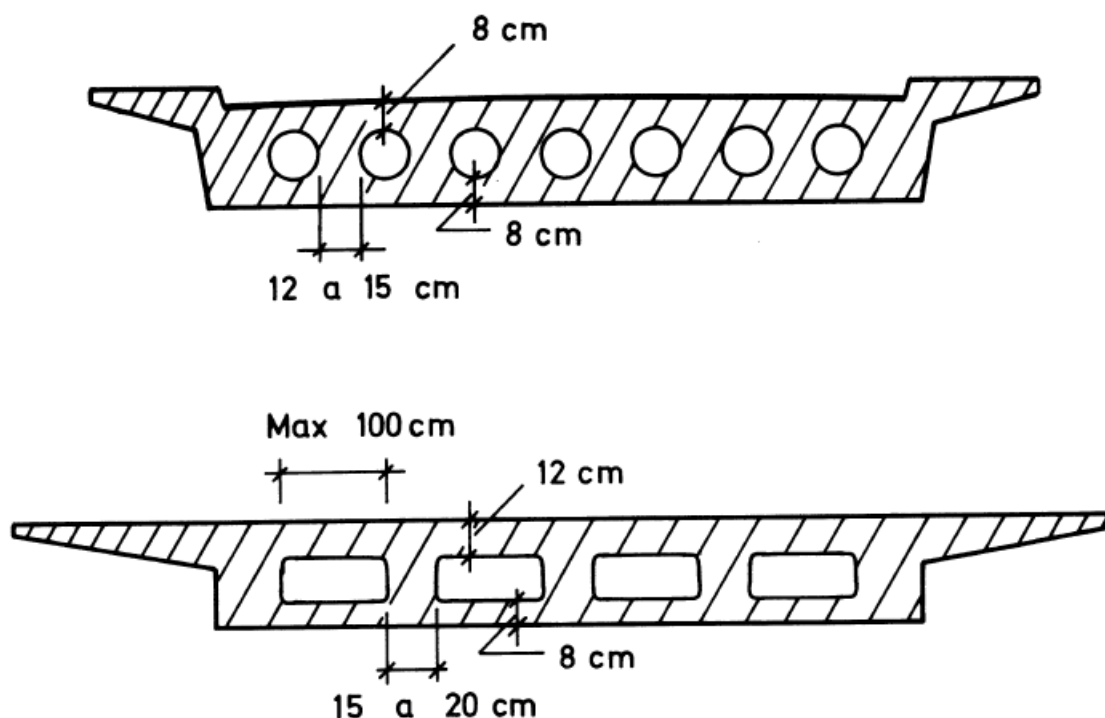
Aligeiramento de secções transversais de tabuleiros em laje (Reis, 2006)
